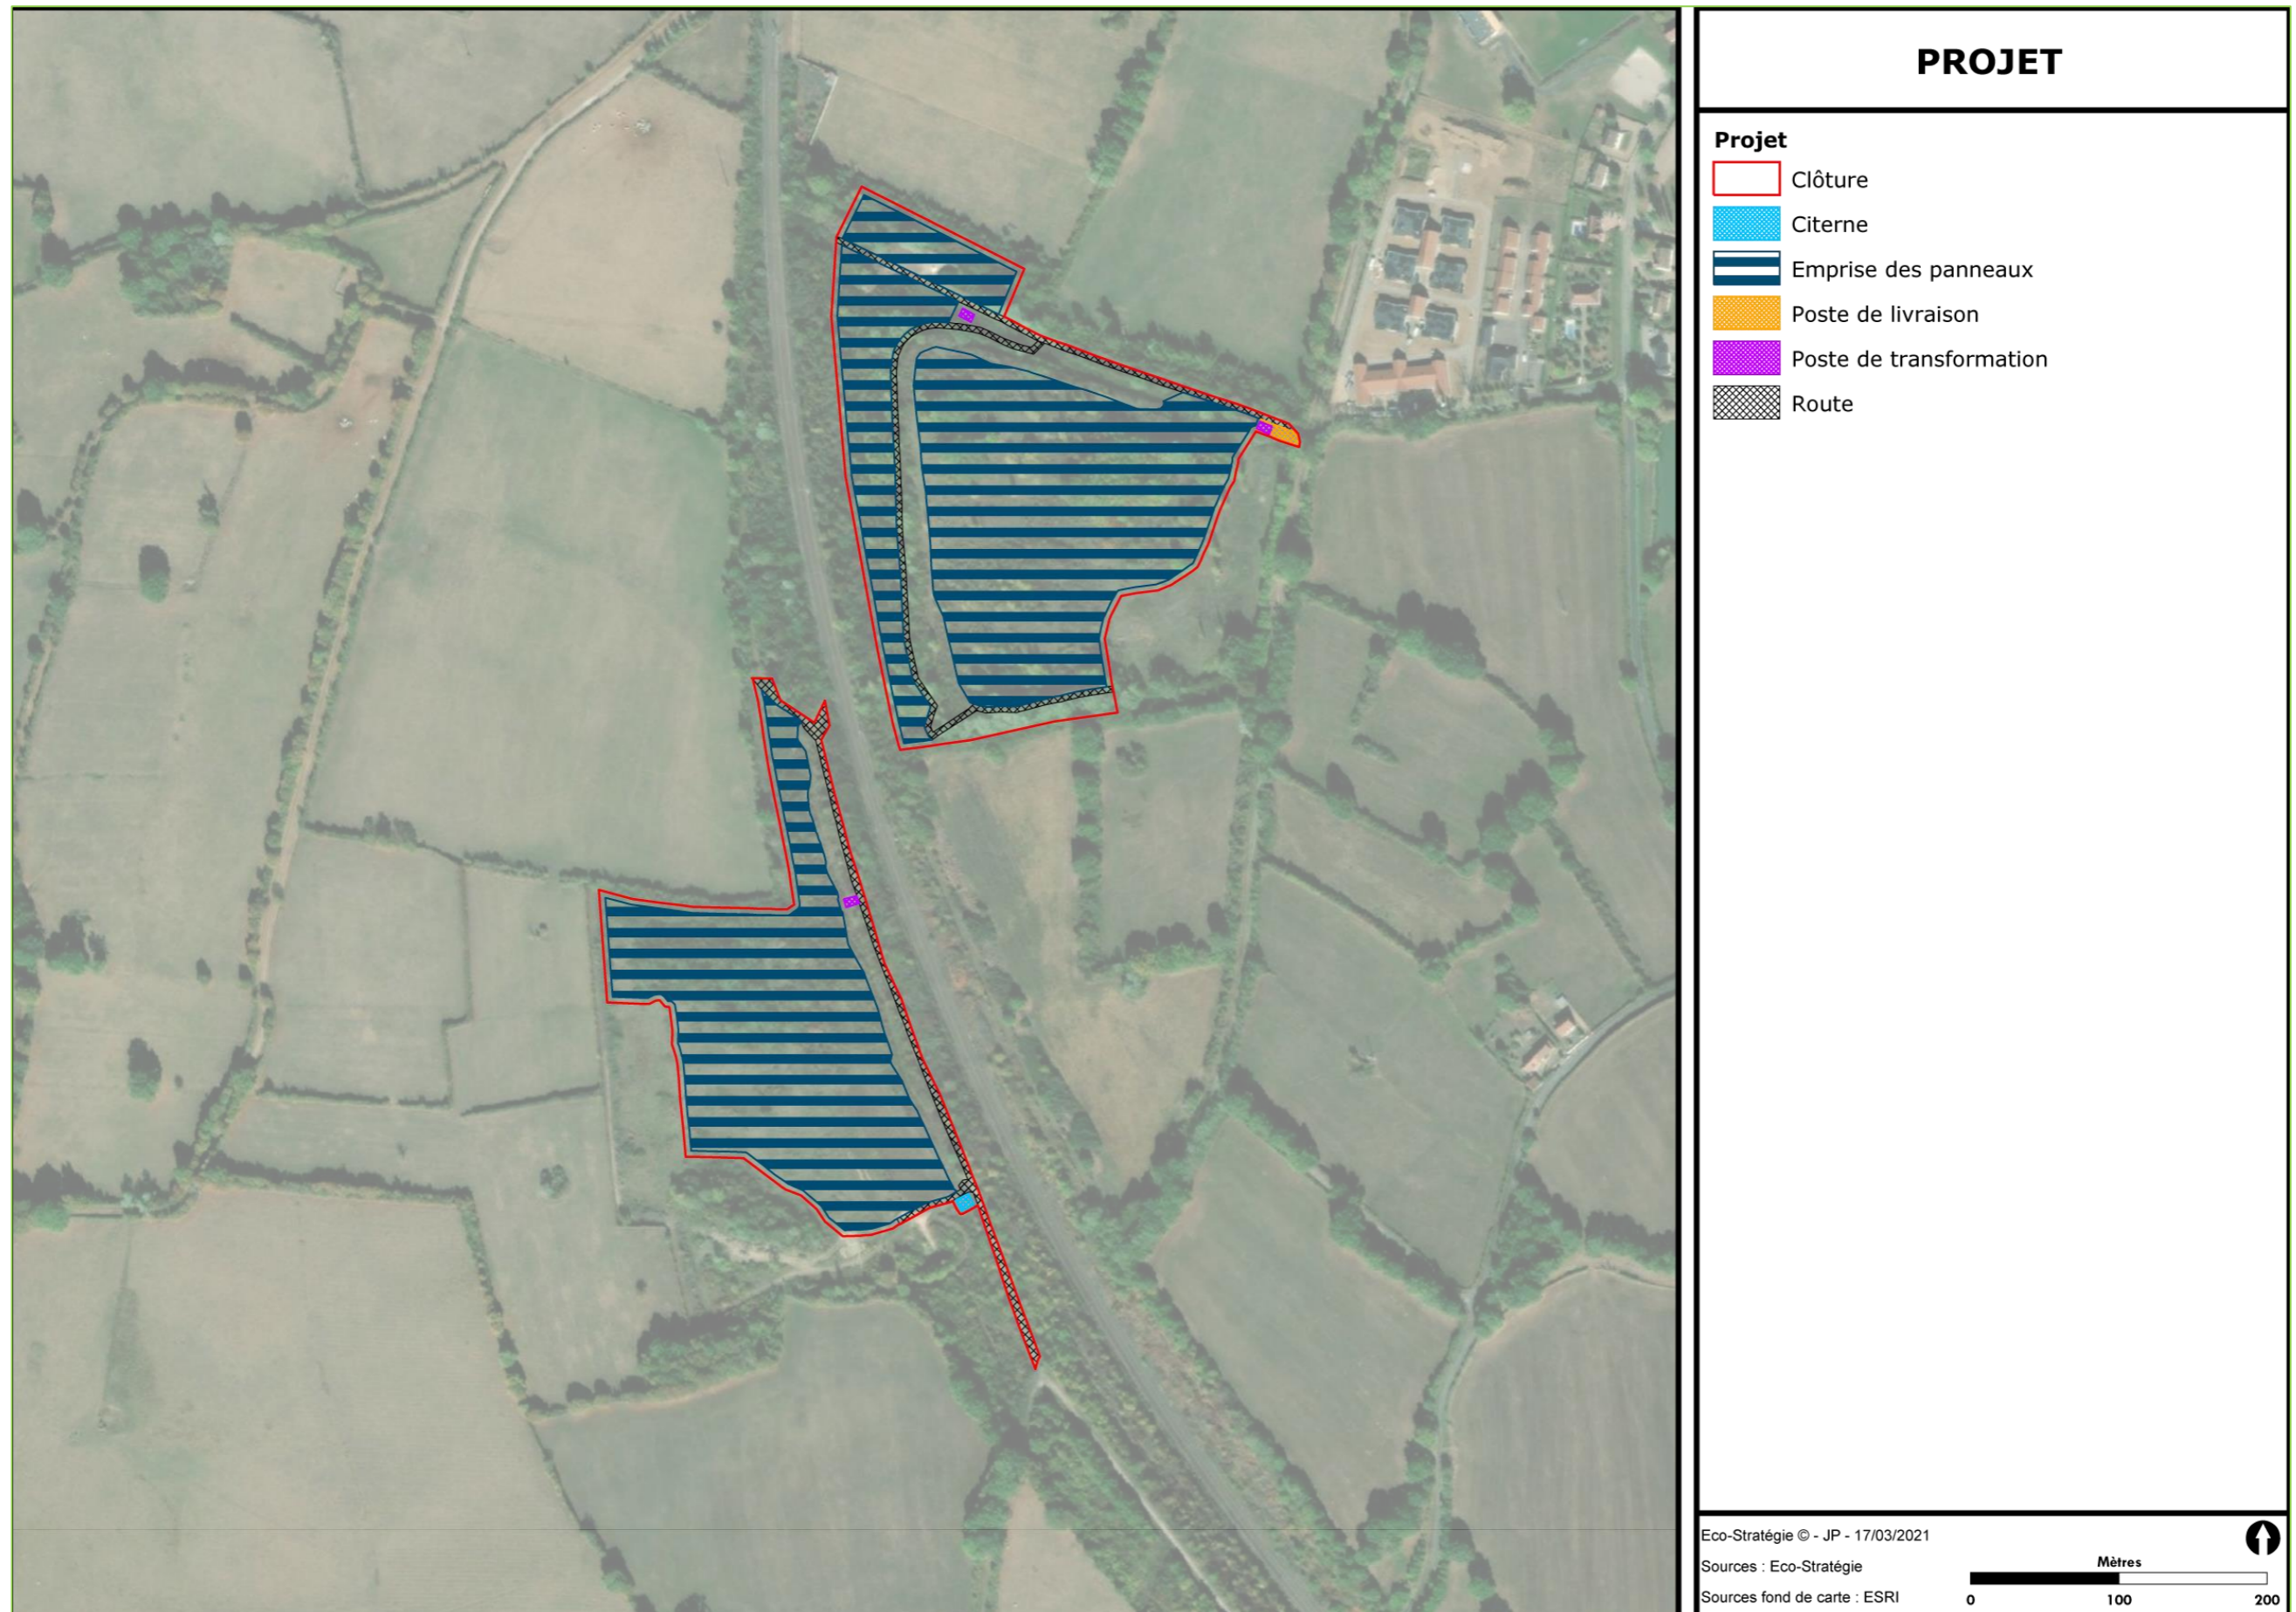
Plan de masse du projet de Saint-Pierre-le-Moutier
